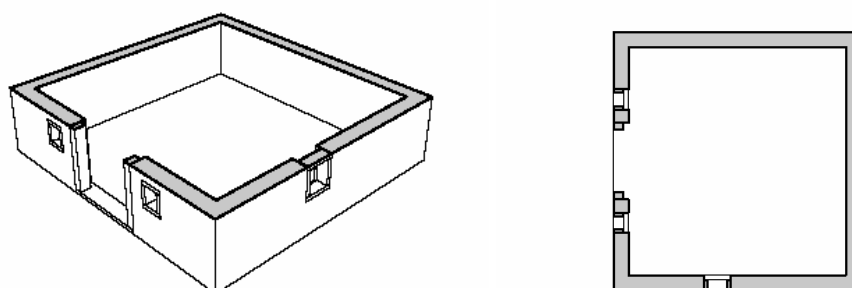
Rappresentazione tridimensionale e pianta della stalla
